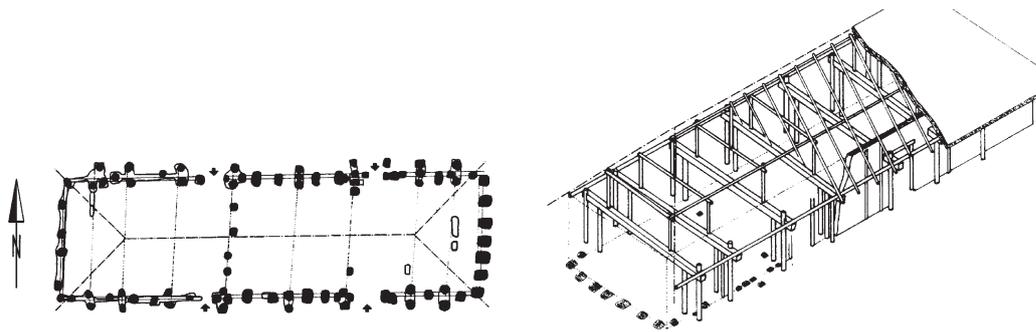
Grundriss und Rekonstruktion eines Hauses aus Odoorn (nach Huuts 1992, 144, Abb. 149).
